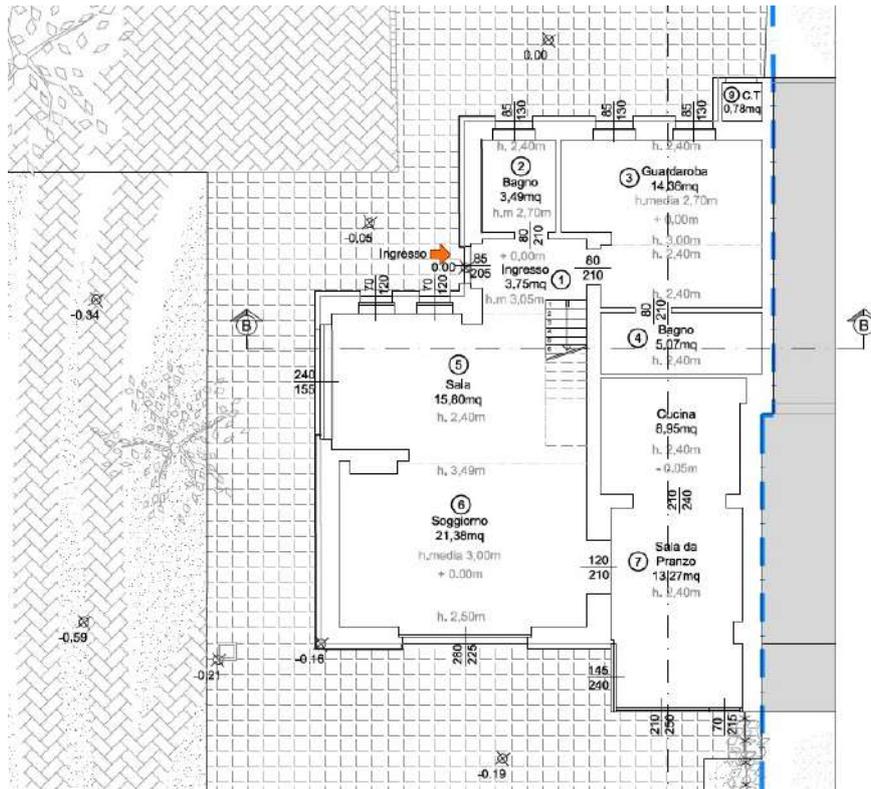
VARIANTE ALLA SCIA n°14755 del 13/12/2022 stralcio tavola di progetto in variante del piano terra
